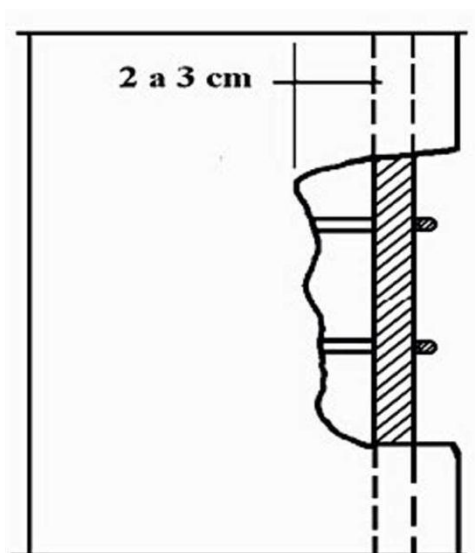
Profundidade de remoção para o procedimento de corte do concreto.
